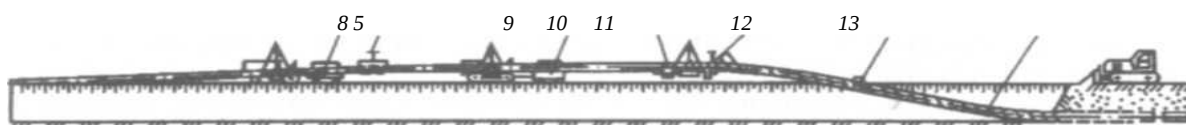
Технологическая схема капитального ремонта с заменой изоляционного покрытия, частичной заменой и ремонтом труб с подъемом трубопровода и укладкой его на берме траншеи:
